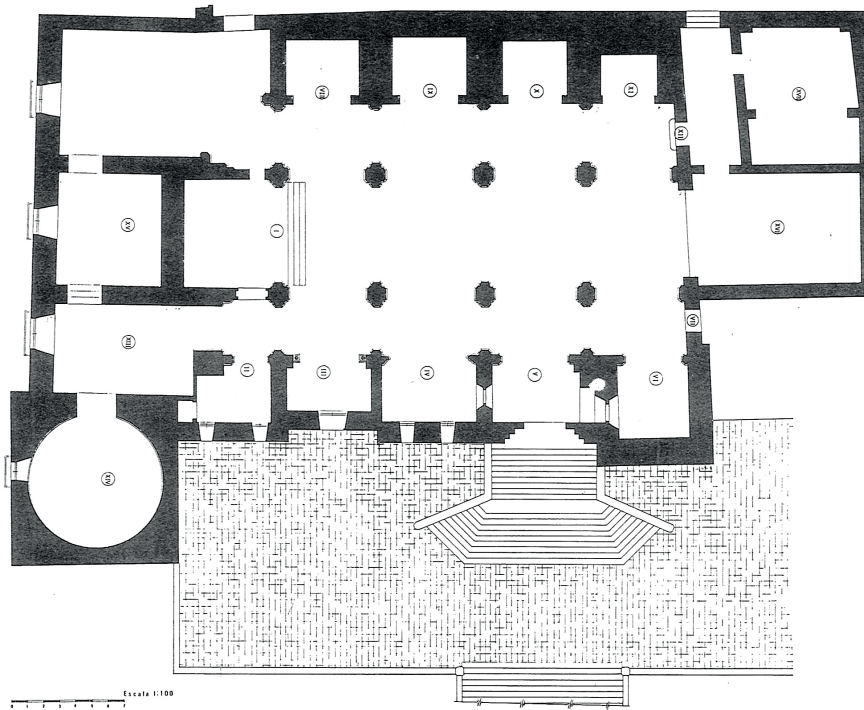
Planta de la iglesia de Santa María de El Puig (Dominguez)
